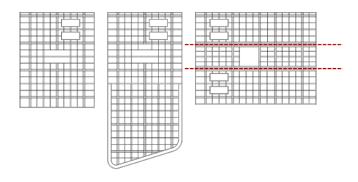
(b) Denah Pembalokan Lantai Basement
